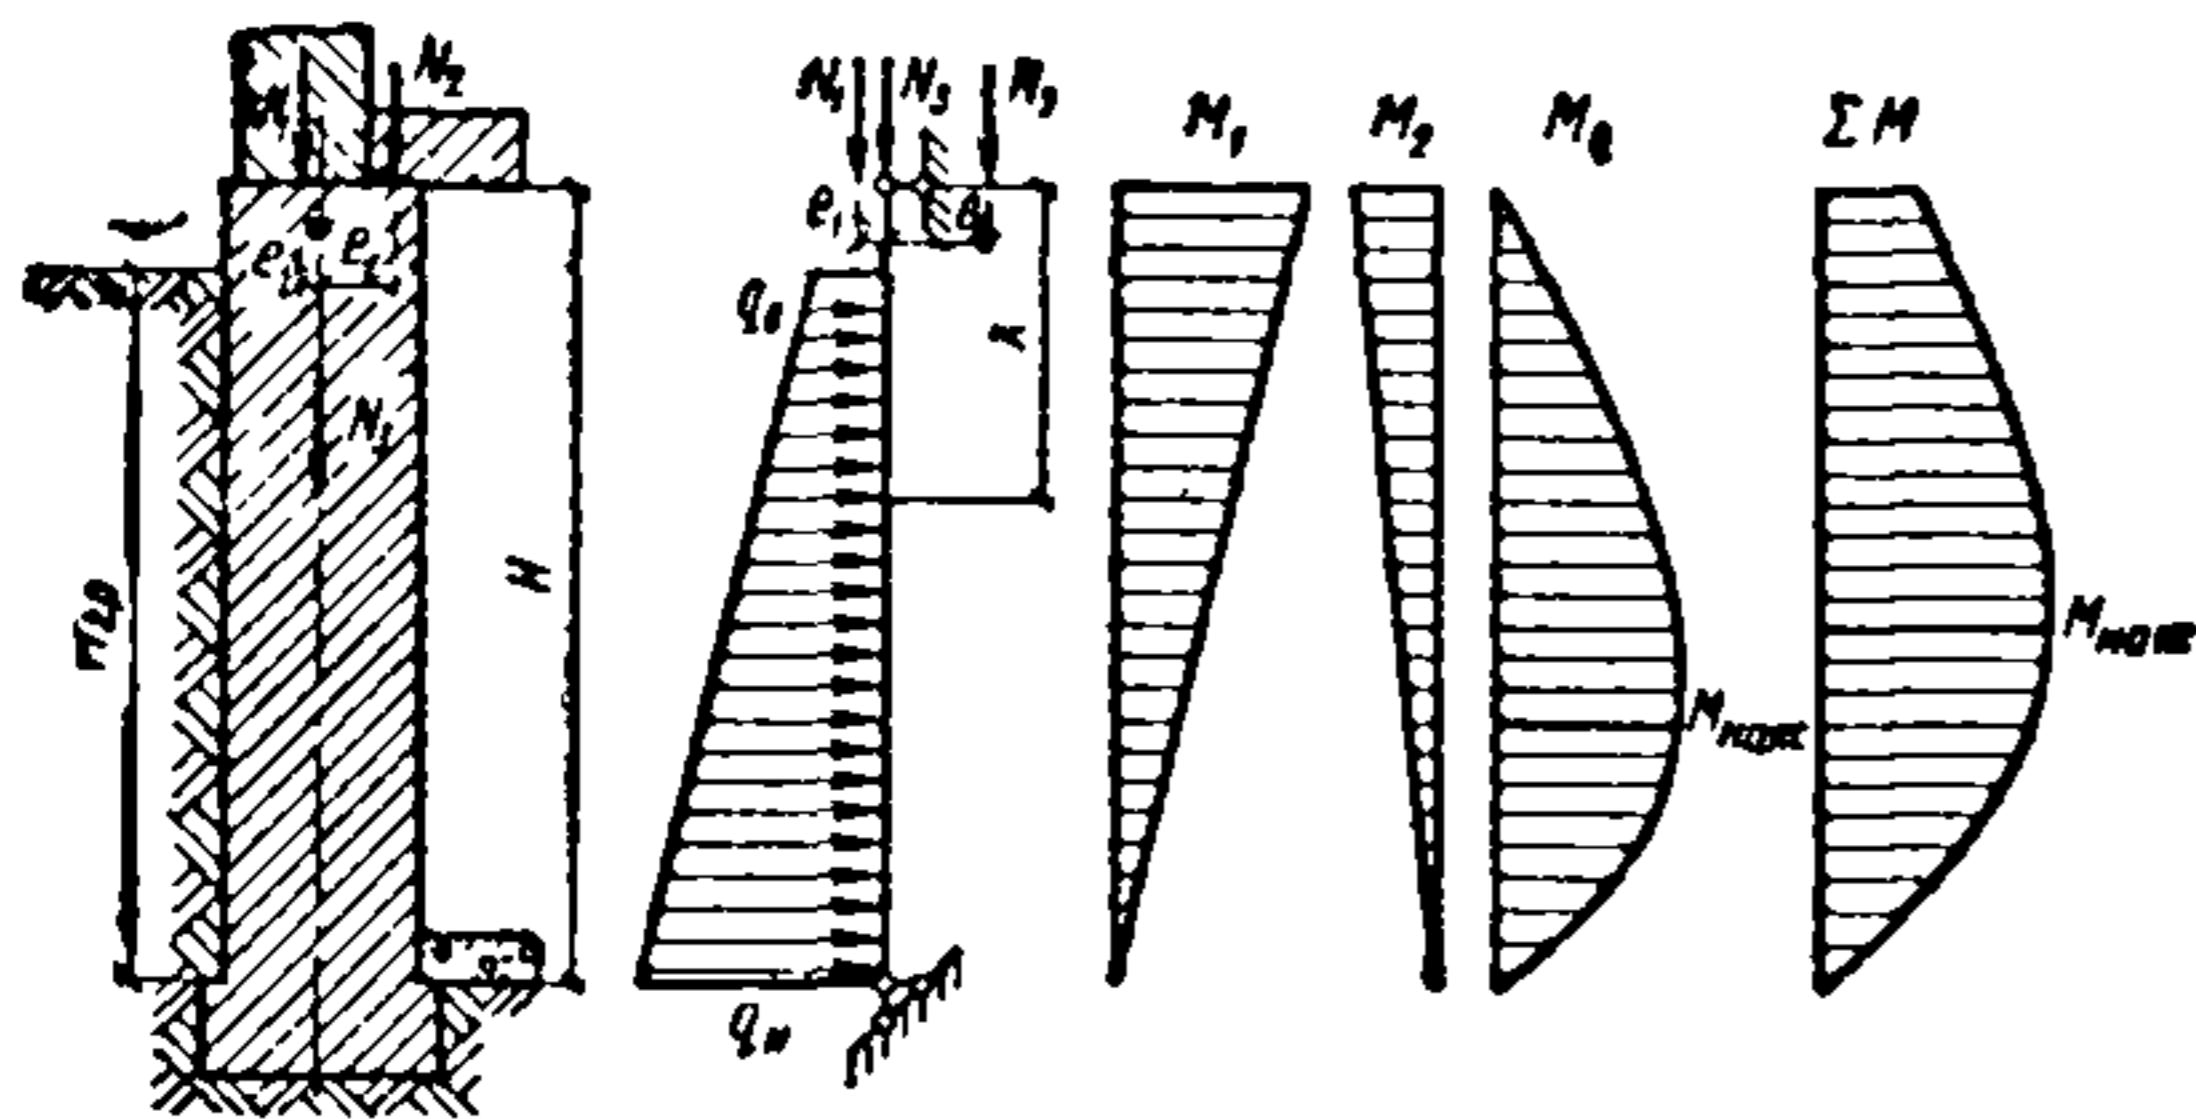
Схема нагрузок на стену подвала и эпюры моментов
